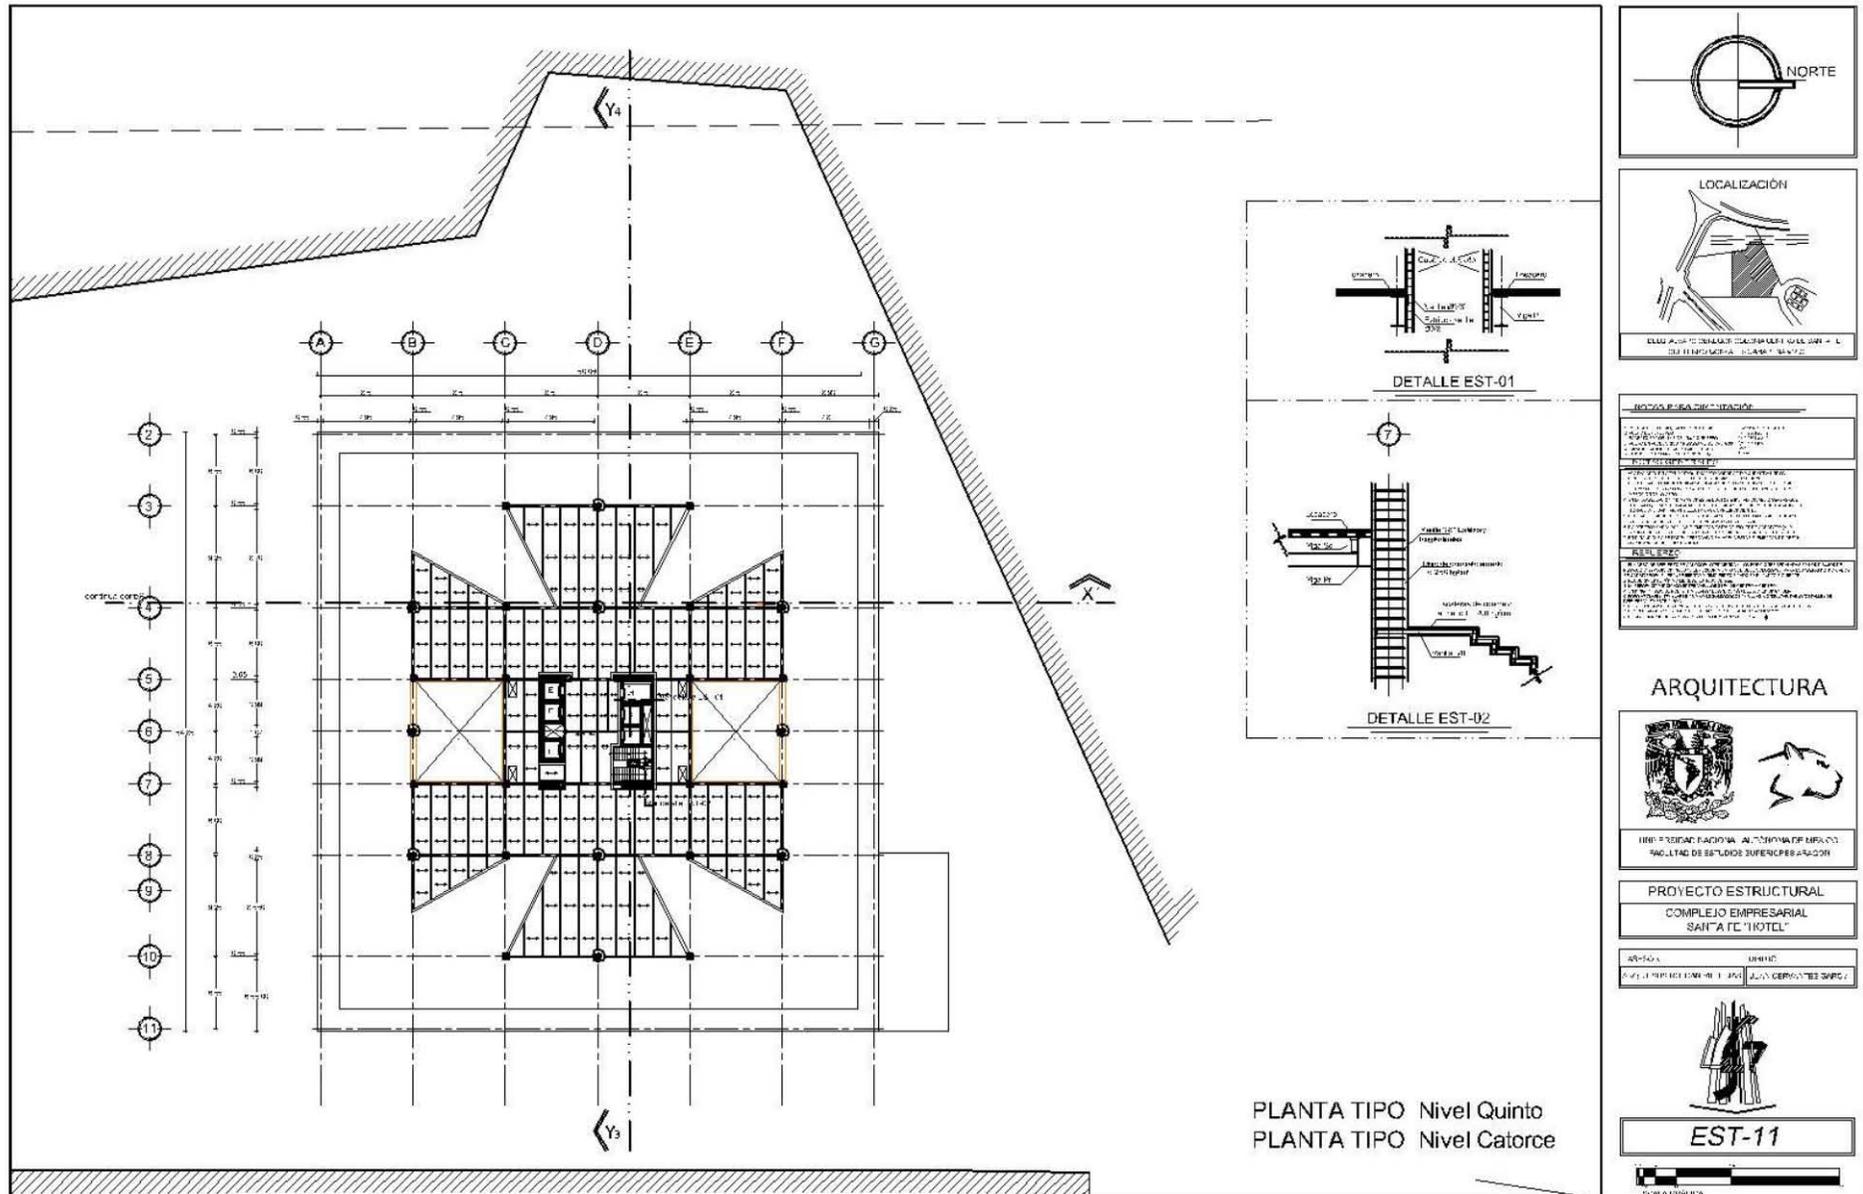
Plano Est-11; Disposición de losacero en planta tipo de cuartos del hotel. Edición propia.
